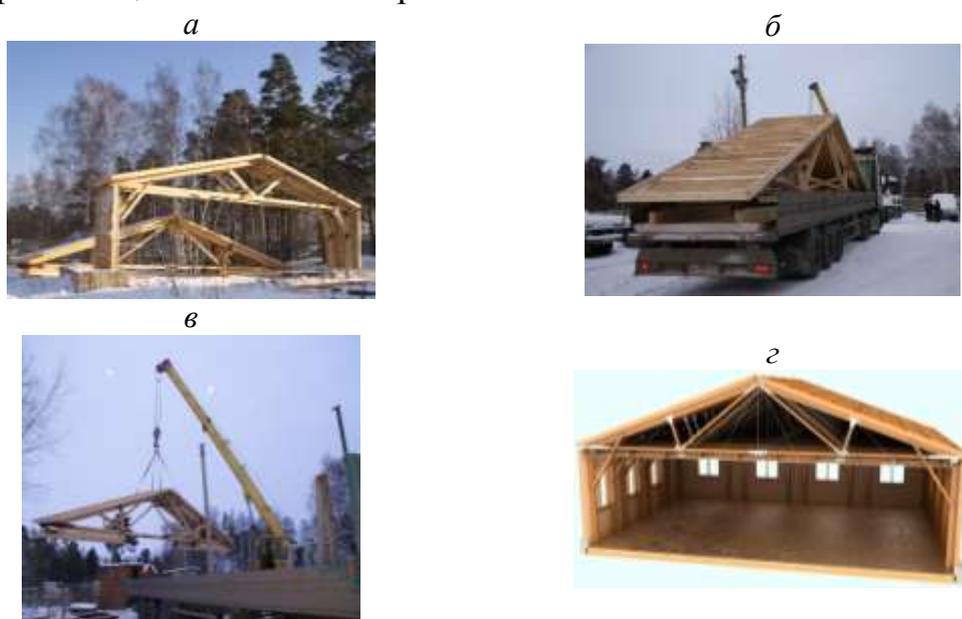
Быстровозводимые здания из рамнопанельных блок-секций, устанавливаемых на фундаментные платформы: *а* – конструктивная схема блок-секции; *б* – транспортировка и *в* – разгрузка конструкции; *г* – фрагмент жилого дома
